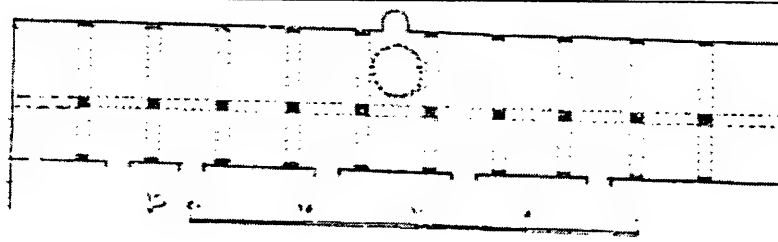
المسقط الأفقي لمسجد خان الزبيب .
